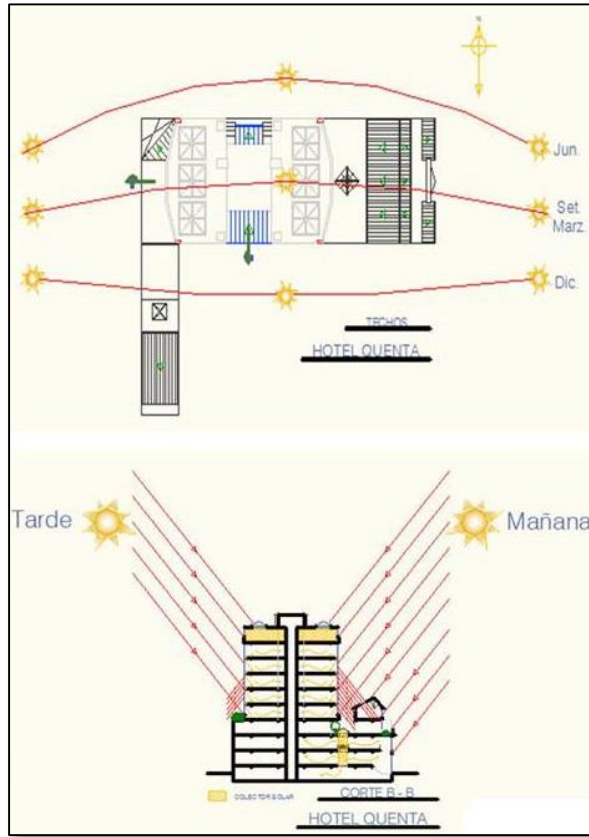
Orientación. Fuente: Arquitecto Hugo Zea Giraldo.
